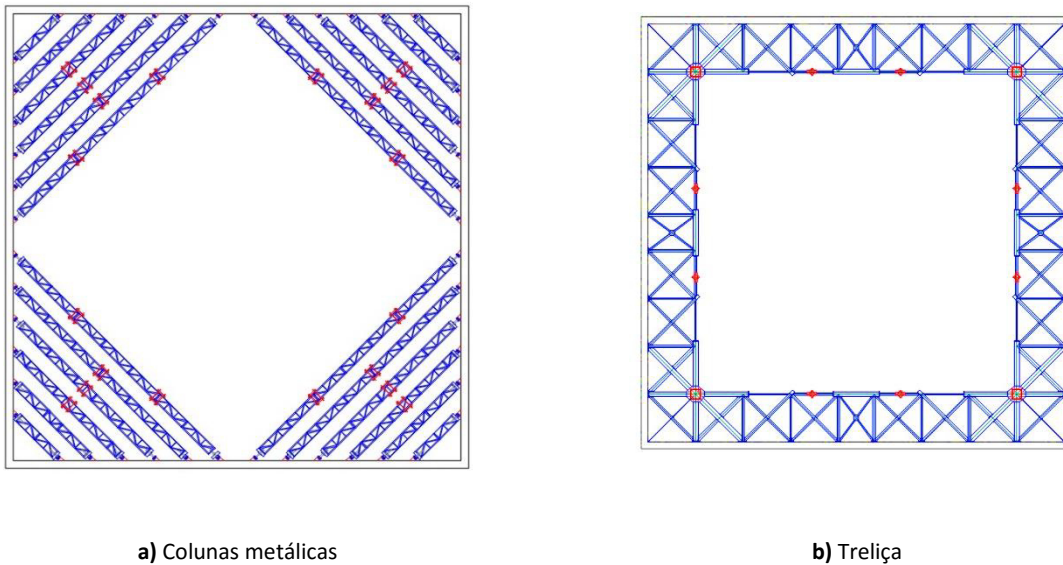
Sistemas de apoio tipo para escavação quadrada.
